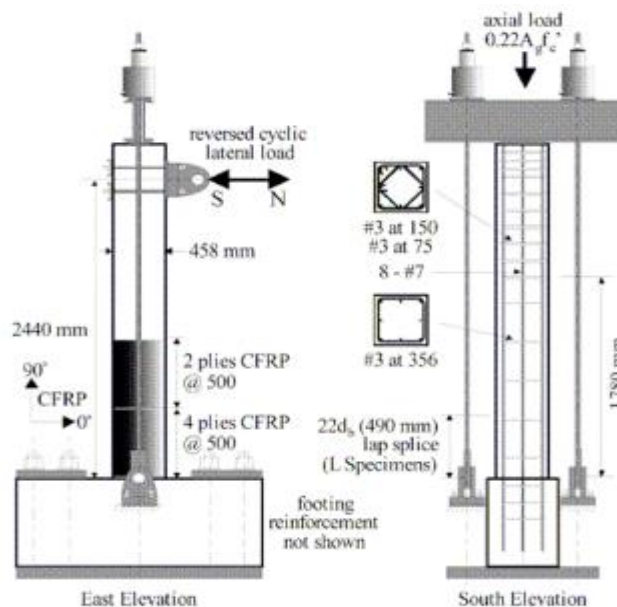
Configuration de renforcement appliquée aux poteaux (Harries et al.)[49]
